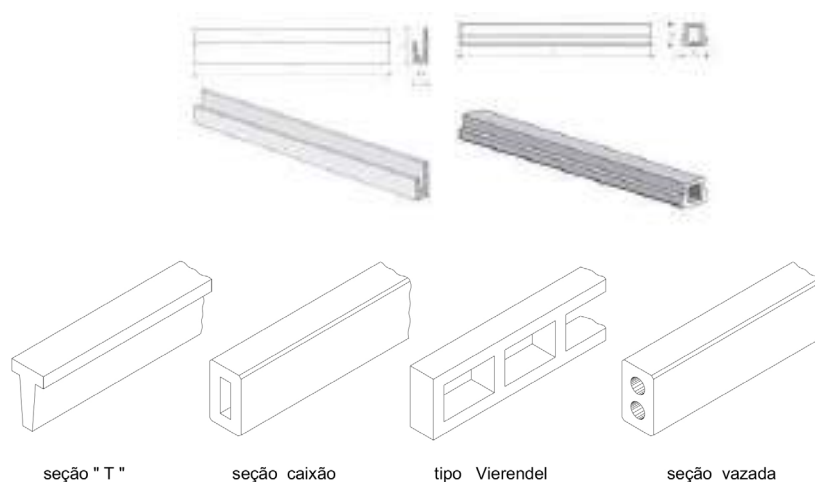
Seções típicas de vigas pré-moldadas de concreto (Fonte: El Debs, 2000)
